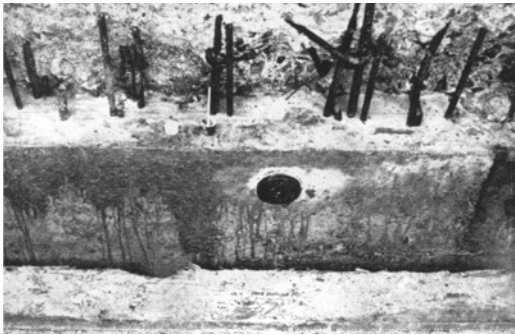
Desarrollo de la prueba de ruptura.
